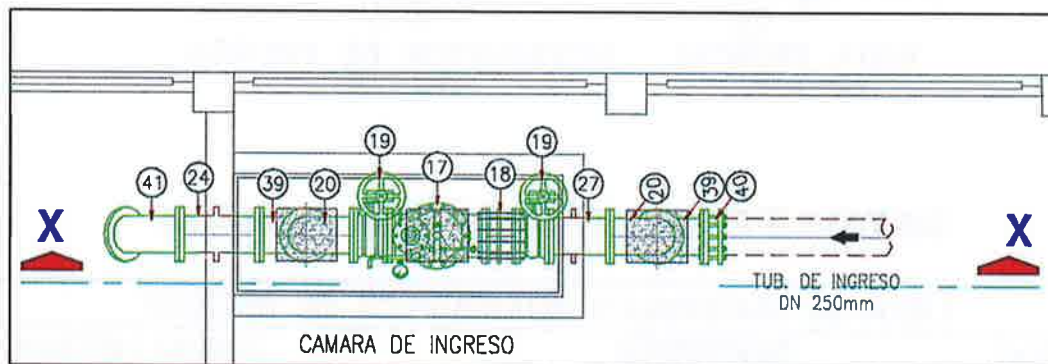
ACCESORIOS CORTE EN LINEA DE INGRESO
